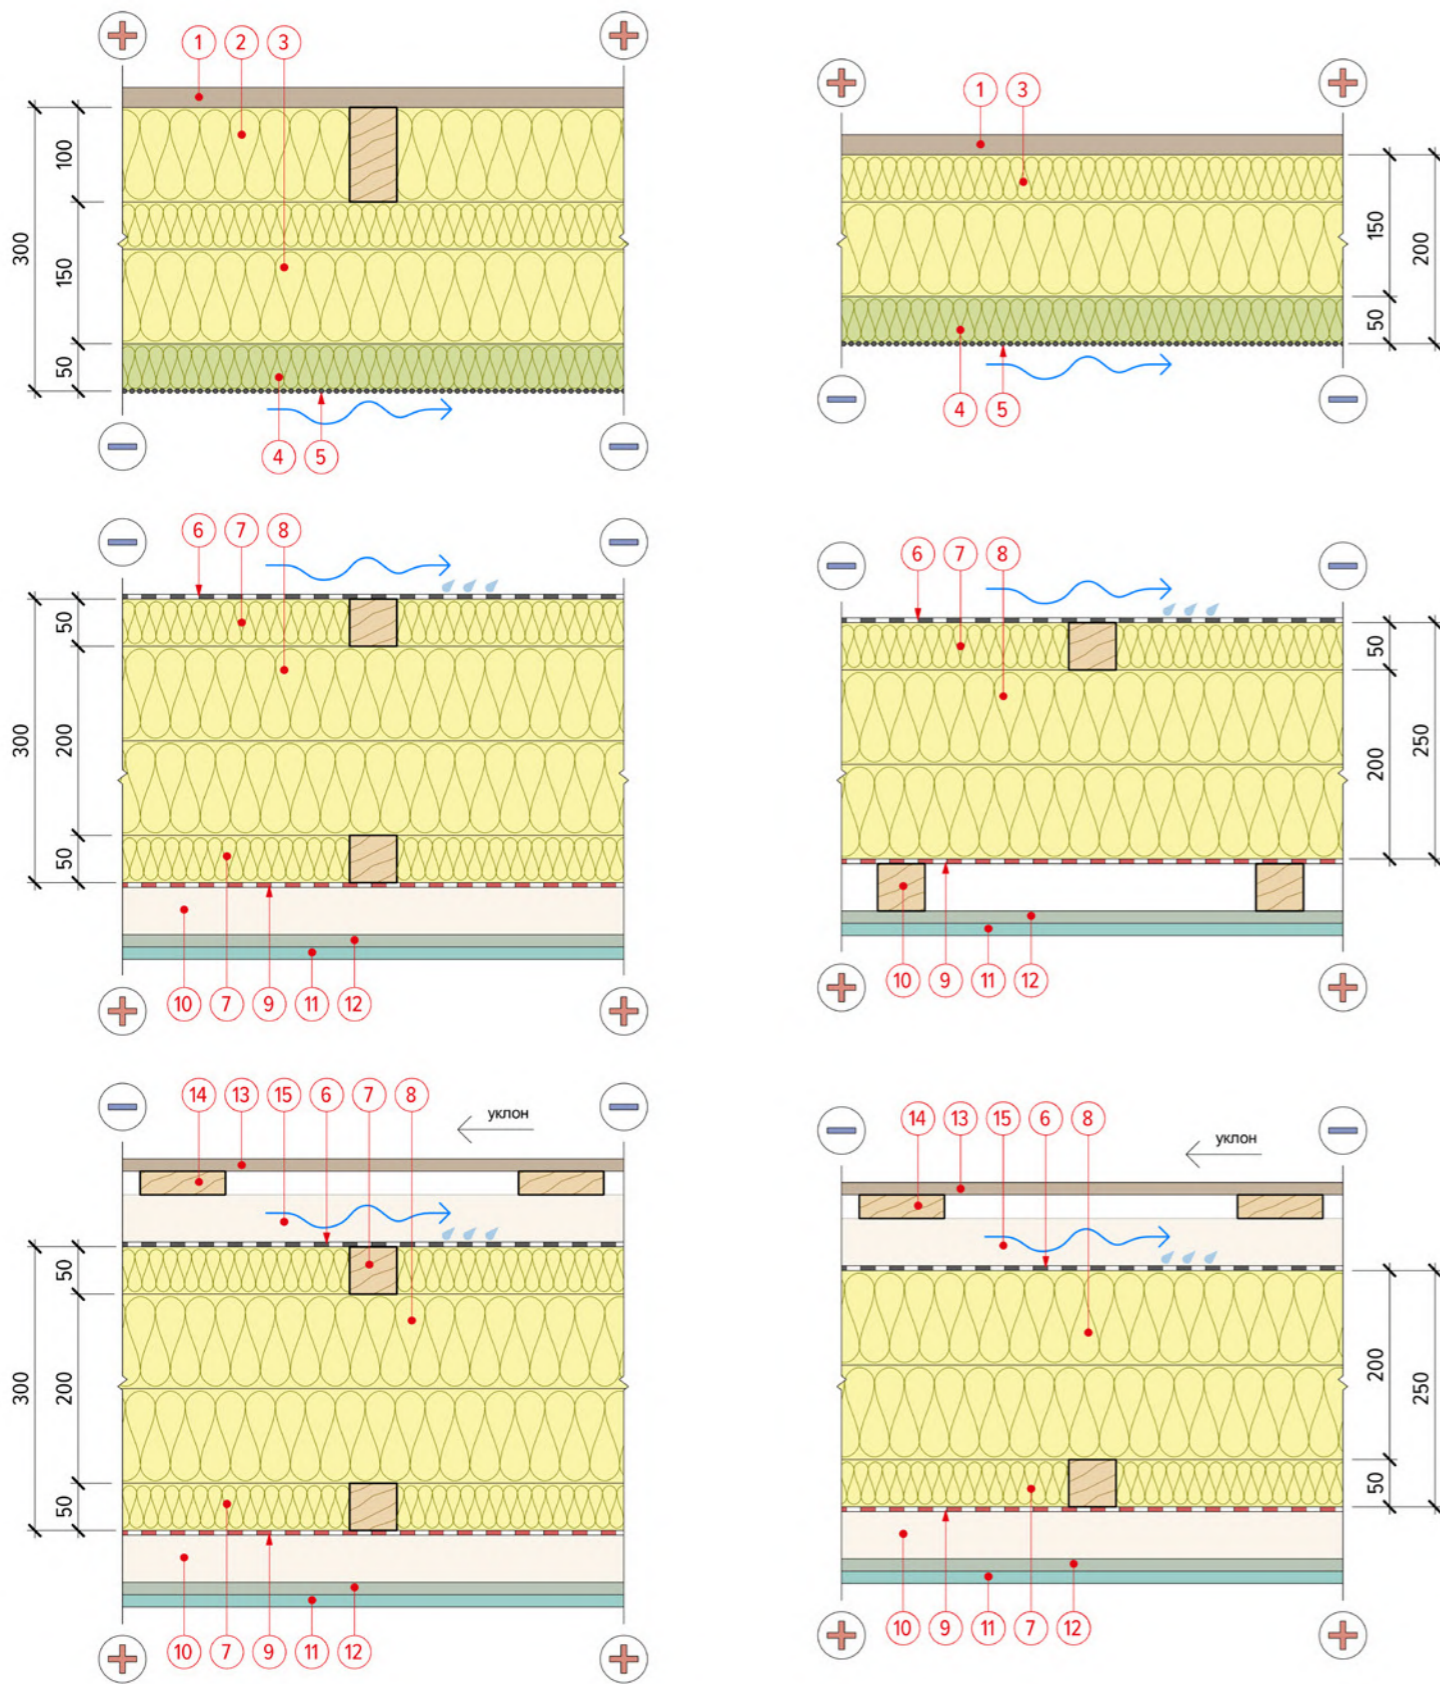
Основные варианты теплоизоляции перекрытия и покрытия
